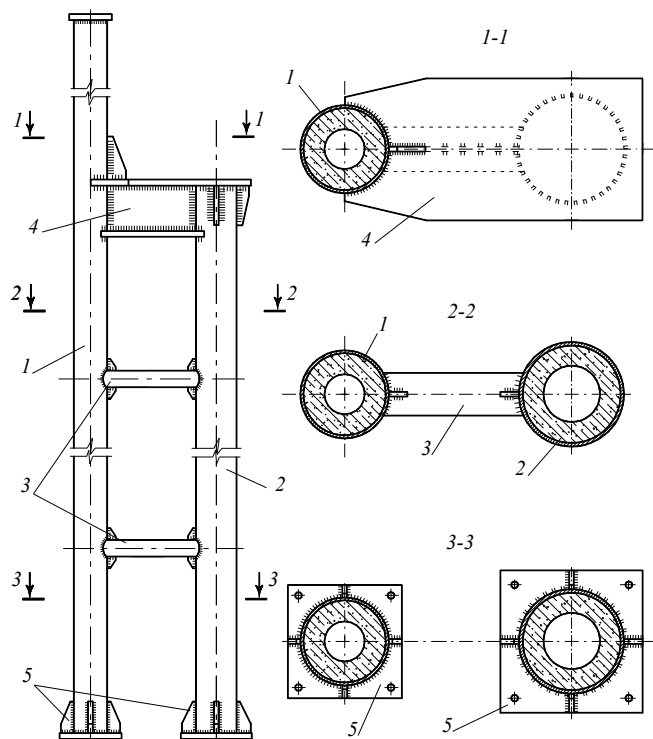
Внецентренно сжатая трубобетонная колонна крайнего ряда одноэтажного производственного здания:
